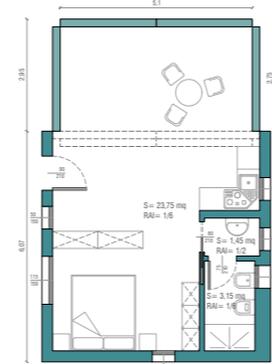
Pianta modulo singolo con pareti aperte - variante 1. Scala 1:200
